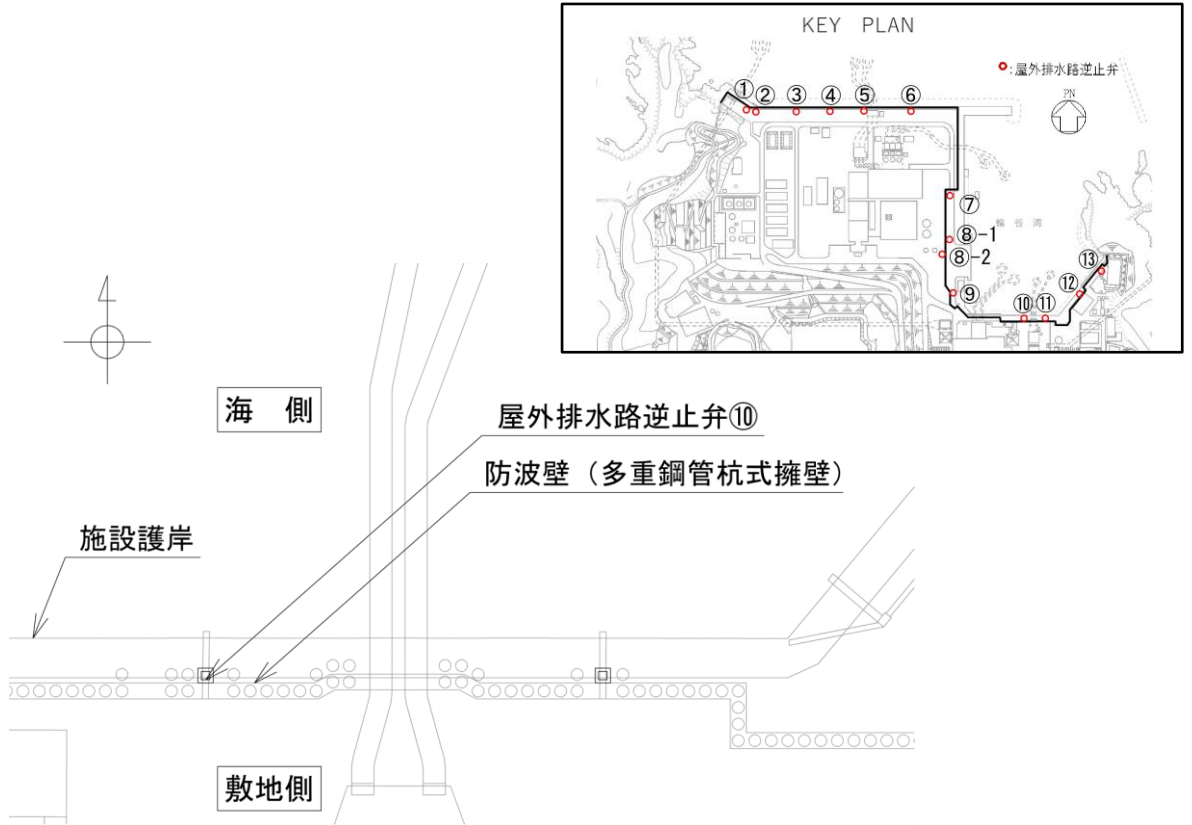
(1) 屋外排水路逆止弁⑩平面図
